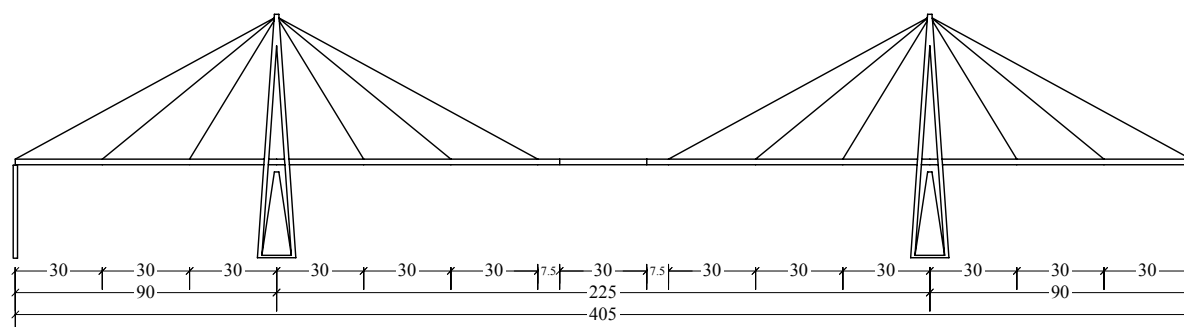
Esquema em alçado longitudinal da ponte da Figueira da Foz.
